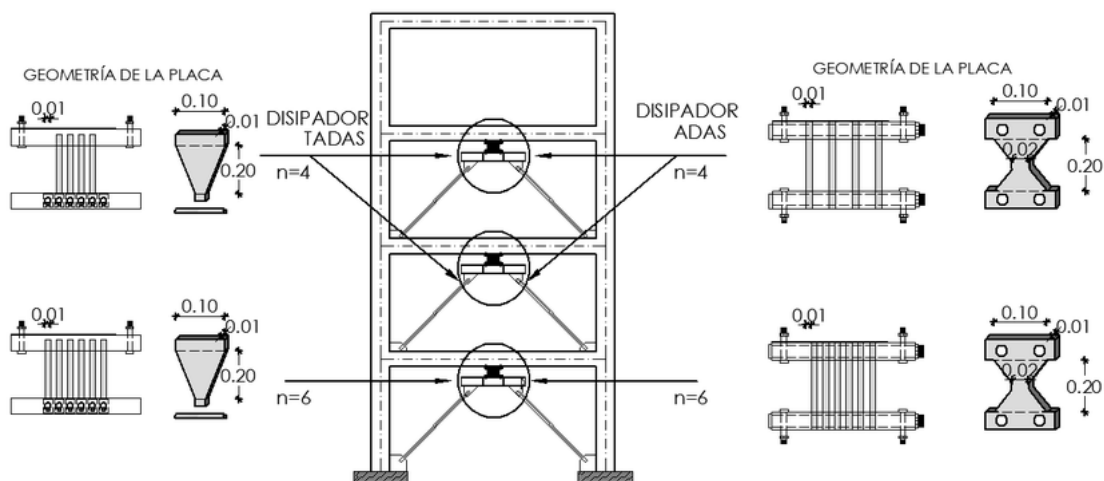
Estructura de pórticos de concreto armado de un solo vano equipada con disipadores de energía ADAS. Fuente: (Nuzzo et al., 2018).
